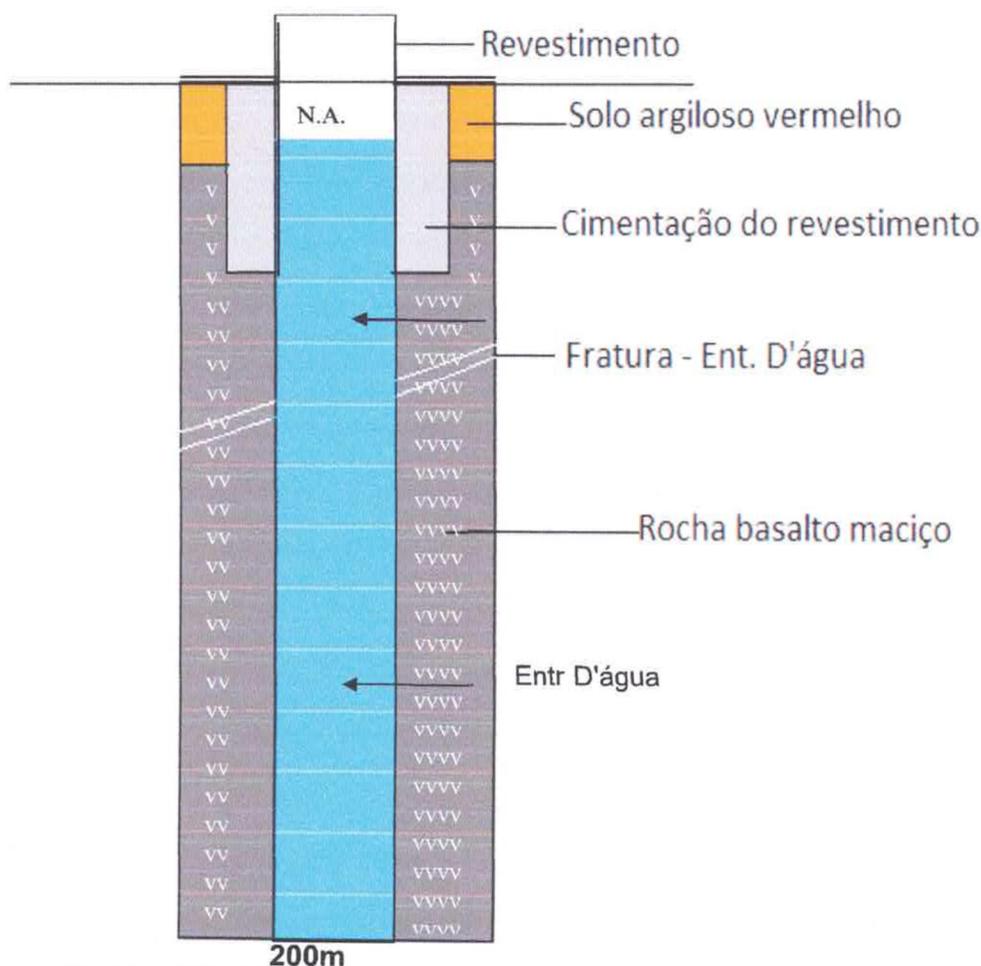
Perfil Geológico e Construtivo do Poço Profundo
